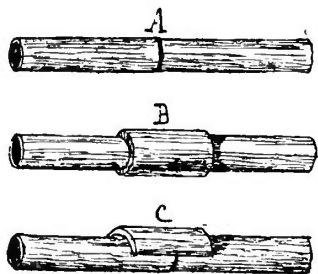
Drains ou tuyaux de drainage. A, nu ; B, avec manchon ; C, avec couvre-joint.
